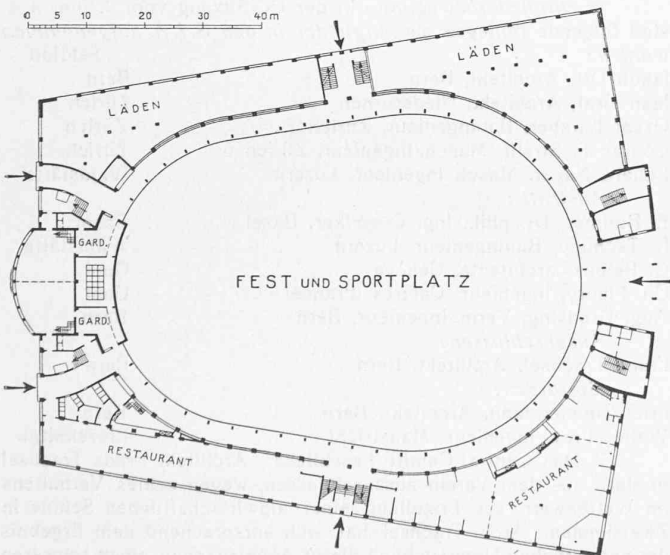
Grundriss des Erdgeschosses. — Masstab 1 : 1200.
